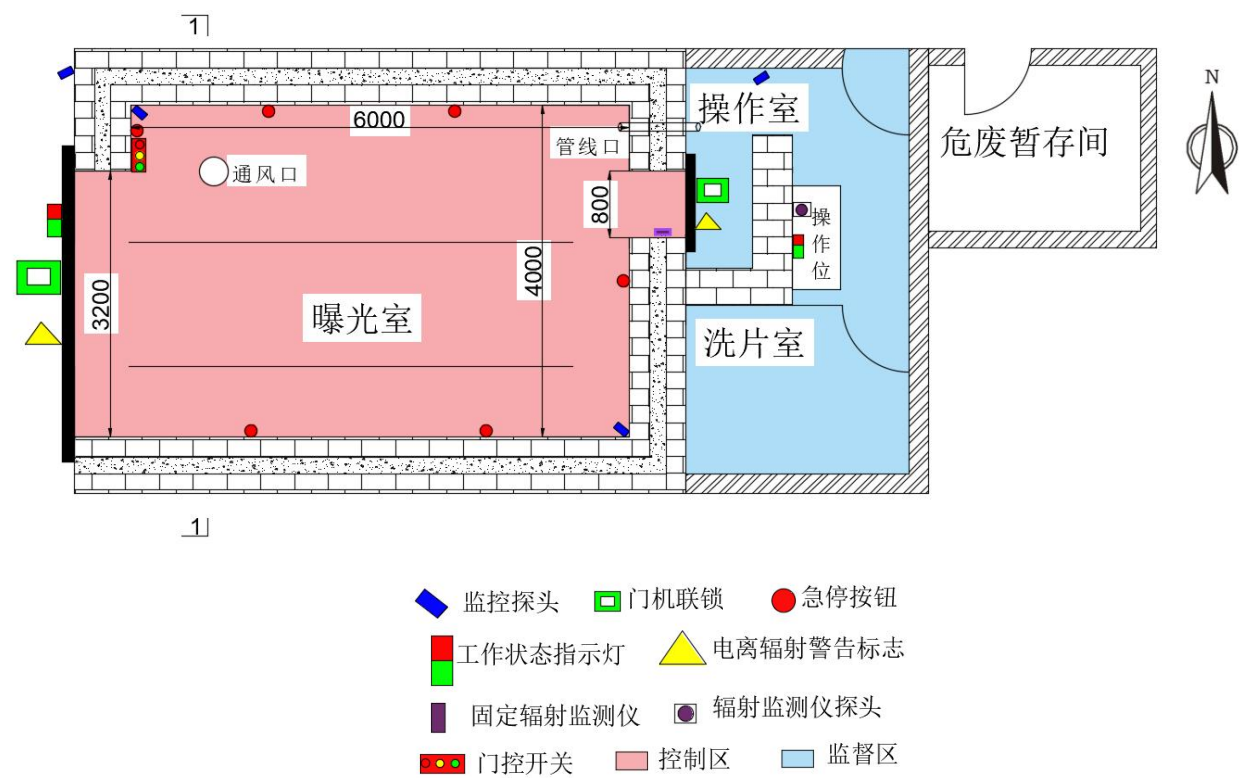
（a） 本项目探伤室面布置图（单位：mm）
